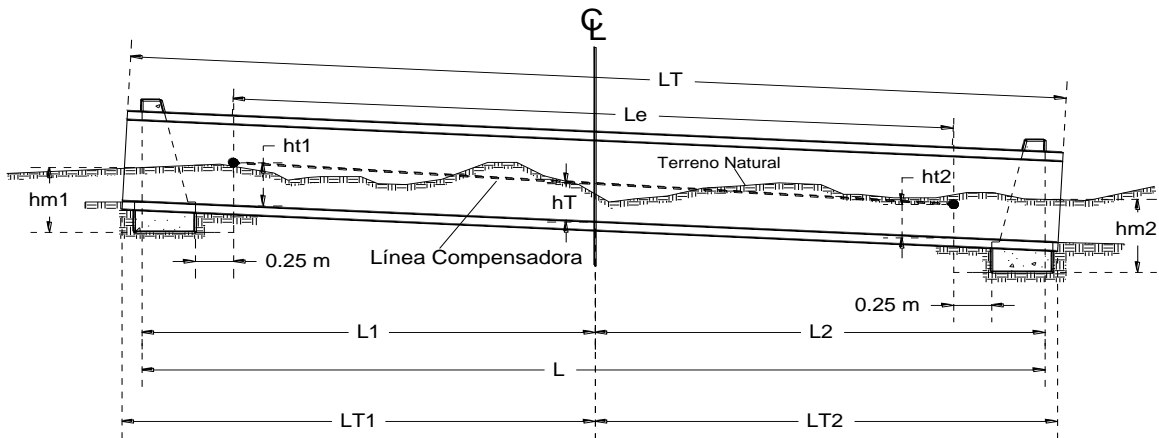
Corte longitudinal de tubo de concreto para proyecto tipo.
